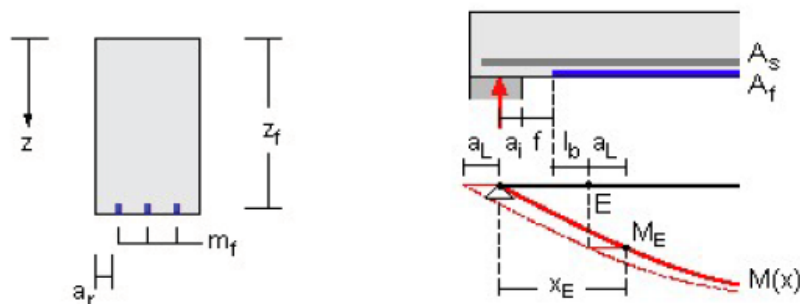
Esquema de posicionamento de laminados inseridos (A_f), corte transversal e longitudinal – Vão 25-26 - Pórtico 5
